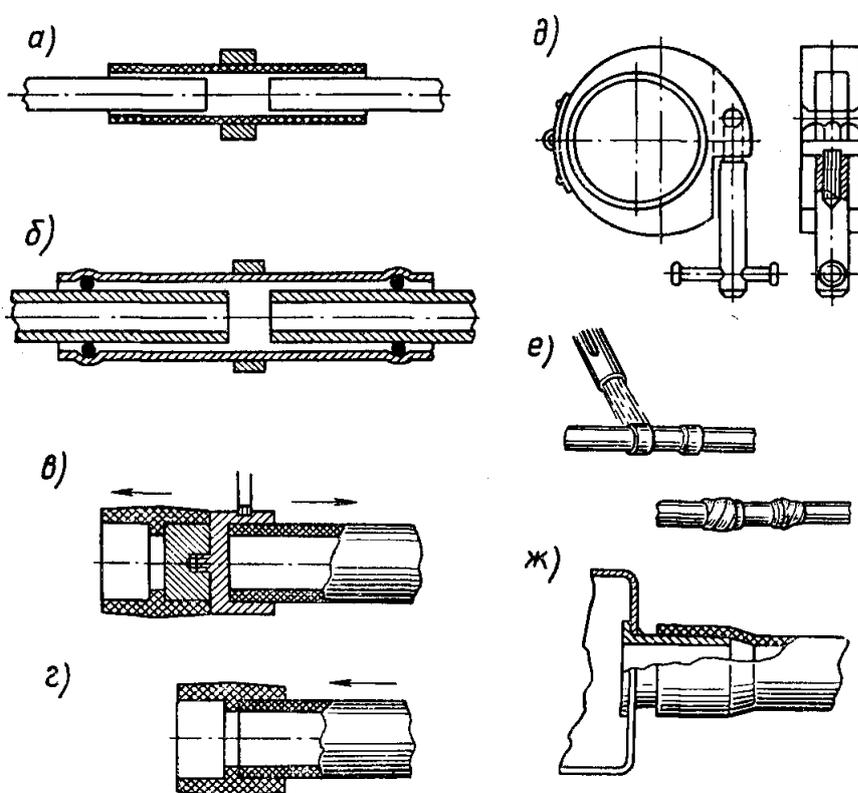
Способы соединения пластмассовых труб: *а* - компенсационное соединение винилпластовых труб без уплотнения; *б* - то же, с уплотнением; *в* - оплавление конца полиэтиленовой полипропиленовой трубы и муфты на оправке для сварки; *г* - сваренные полиэтиленовые и пропиленовые трубы; *д* - ограничительный хомут; *е* - соединение полиэтиленовых и полипропиленовых труб горячей посадкой; *ж* - соединение с коробкой с помощью раструба
